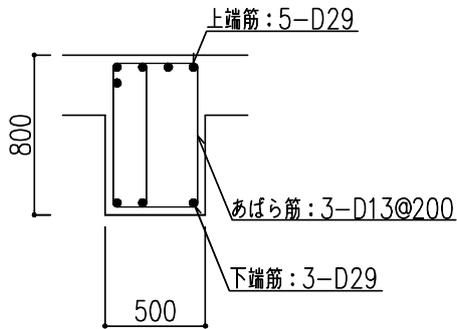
大ばりの配筋図（屋上階，X3 通り YD～YE 通り間，端部）（単位：mm）
